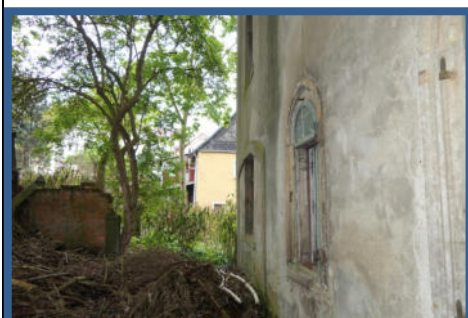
Rückansicht (Nord-Ansicht) starke Beschädigungen an der Fassade; stark verwilderte und beschädigte Außenanlagen; umliegende Bebauung
